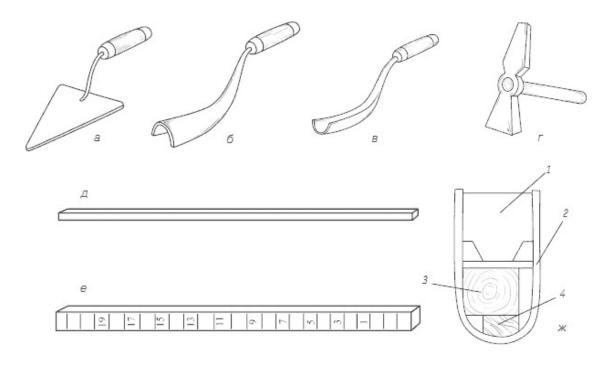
Инструменты и приспособления для кладки: а — кельма; б и в — расшивки для выпуклых и вогнутых швов; г — молоток; д — правило; е — порядовка; ж — держатель: 1 — планка; 2 — скоба; 3 — порядовка; 4 — клин
